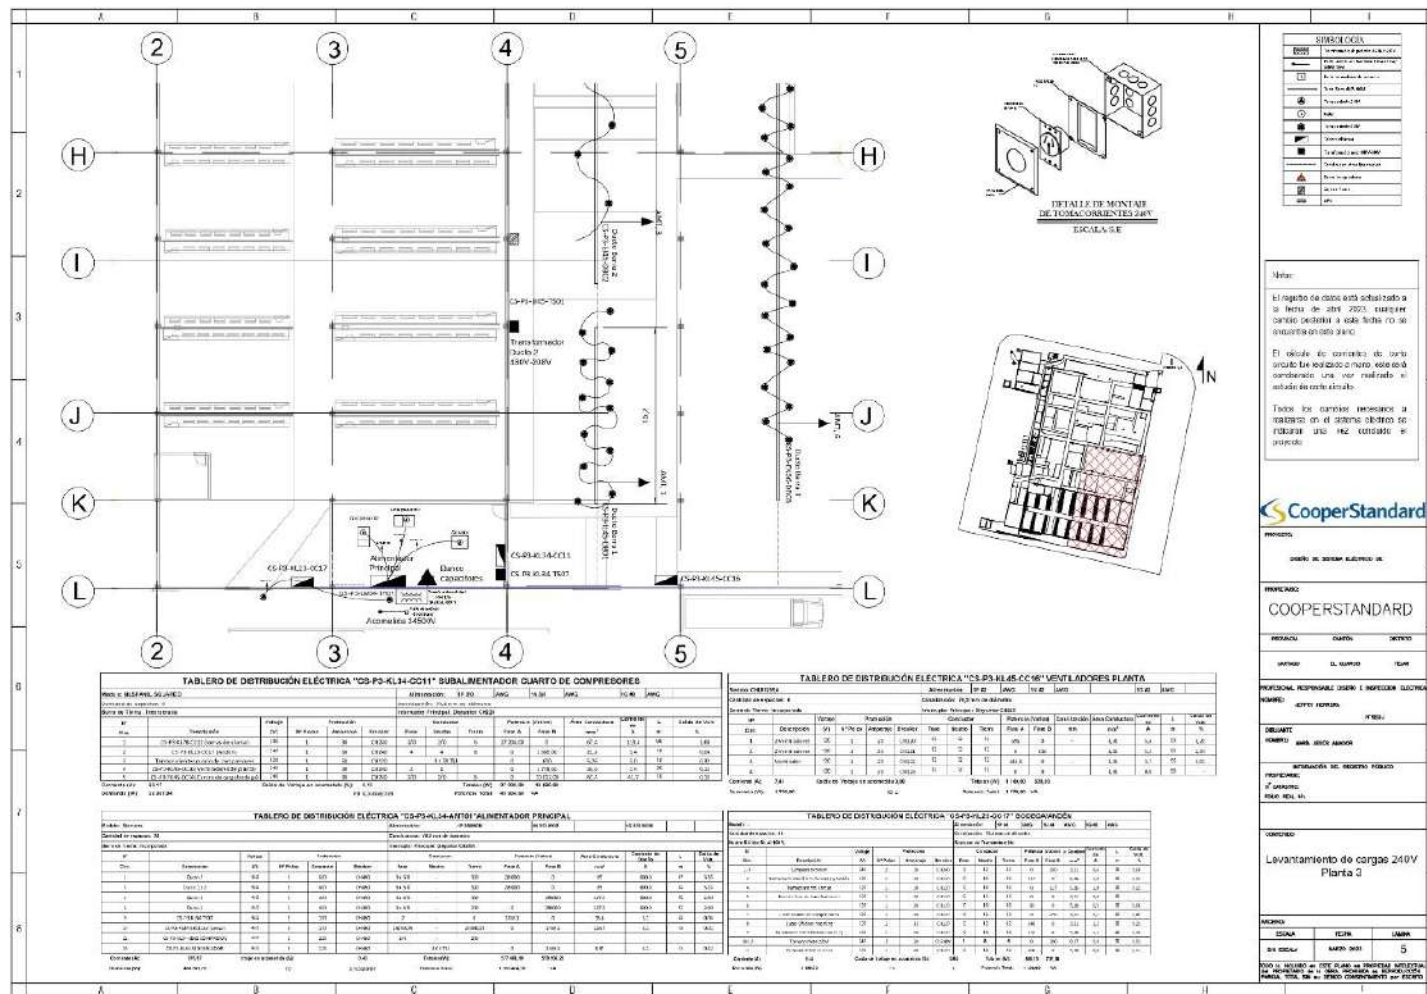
Cargas especiales a 240V, Planta 3 Fuente: Elaboración propia, realizado en AutoCAD (2023).
